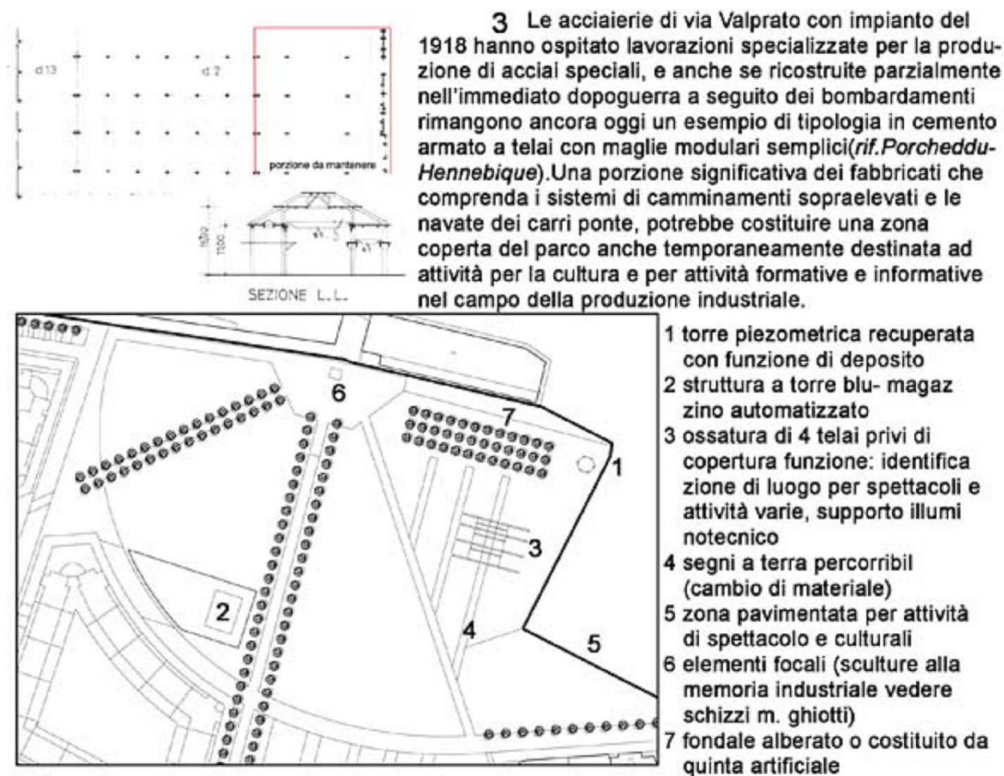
indicazioni del progetto preliminare. Particolare dell'area a parco.
